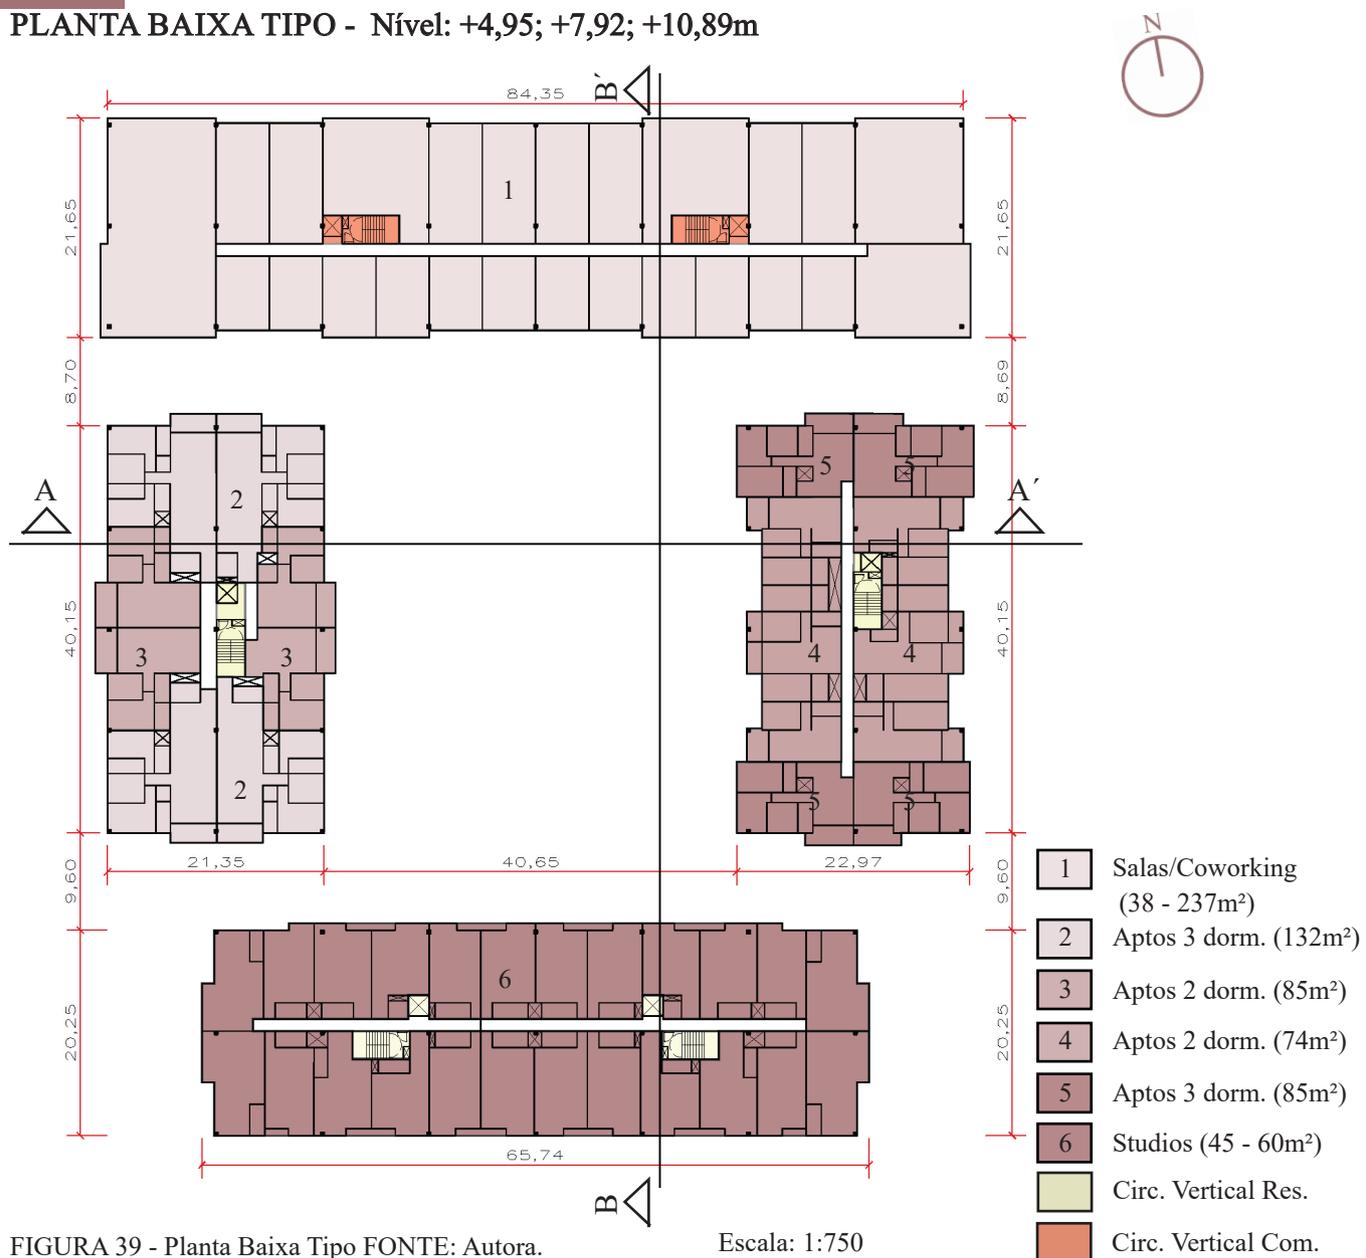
Planta Baixa Tipo FONTE: Autora.
